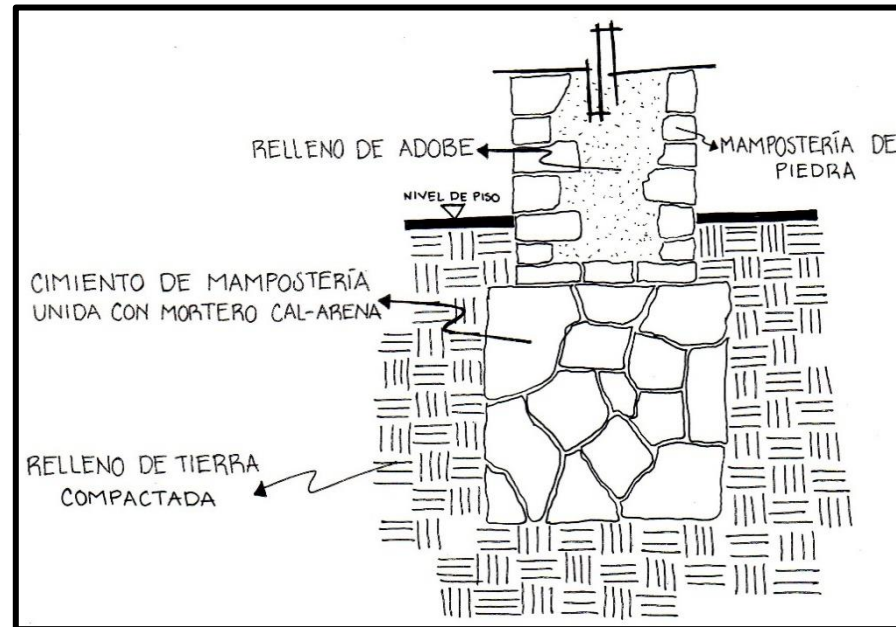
Cimentación de la Parroquia de San Bernardino. (Espinosa M. 2018)
